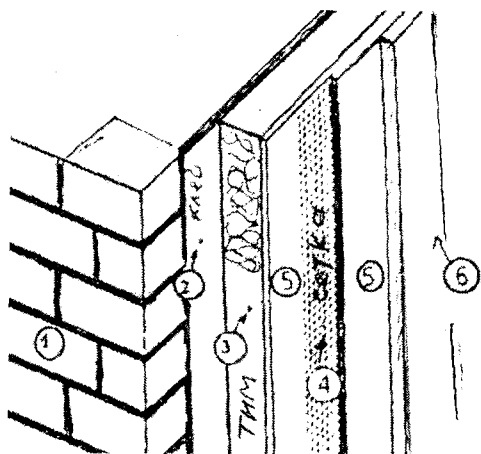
Крепление изоляционного материала к наружной стене с помощью специальных анкеров и клеящего раствора:
